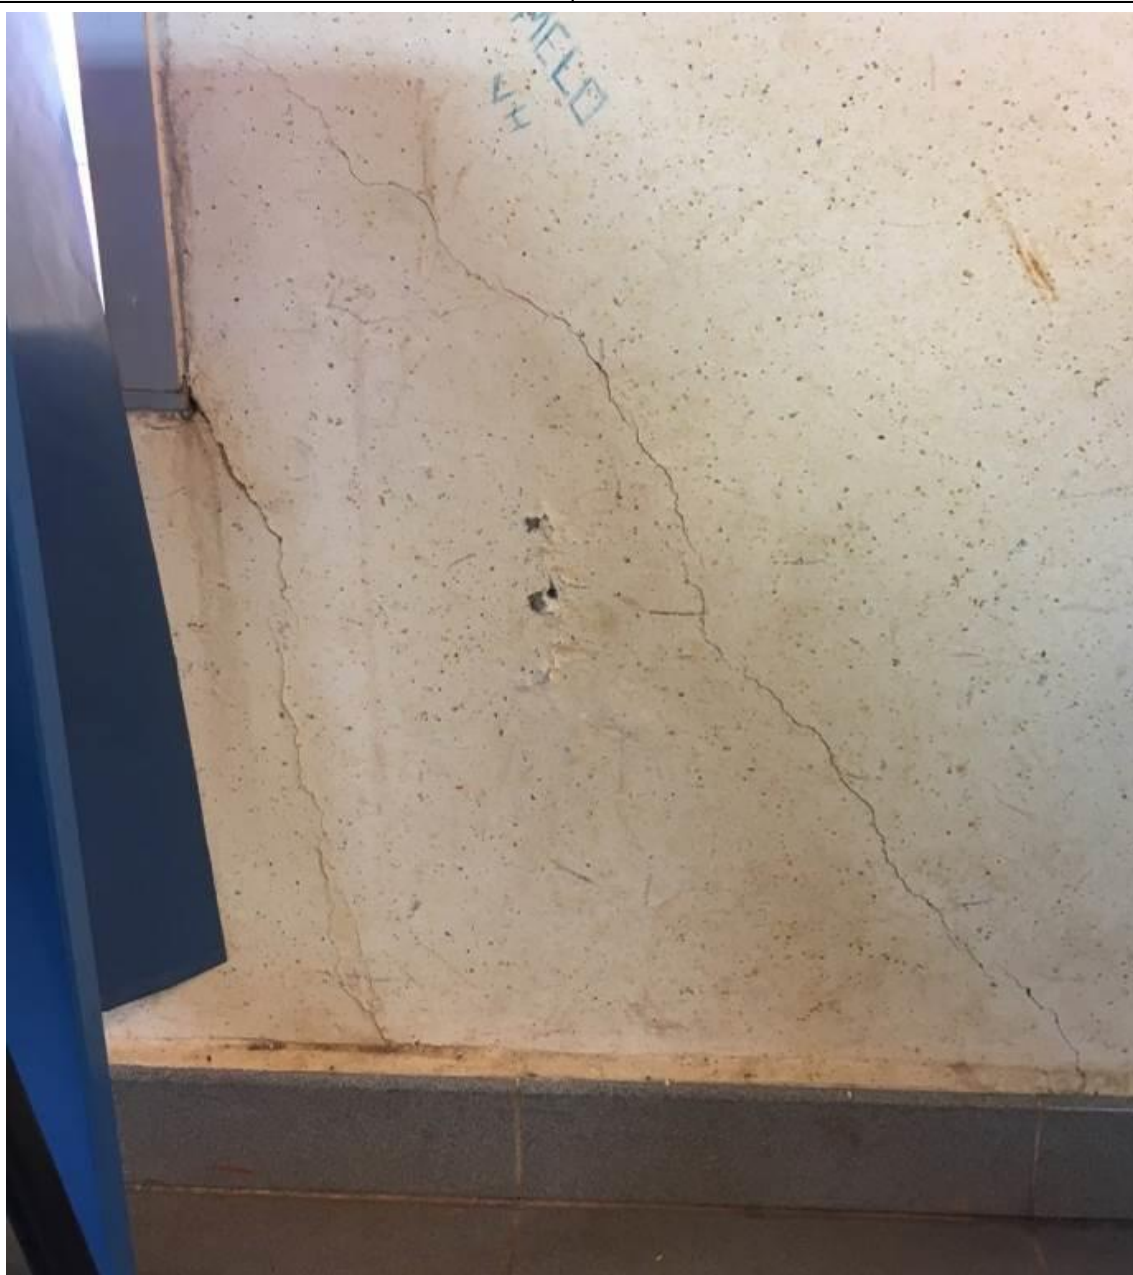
Bâtiment A R+1, extérieur salle polyvalente - Paroi verticale : D2 - Fissuration modérée.
